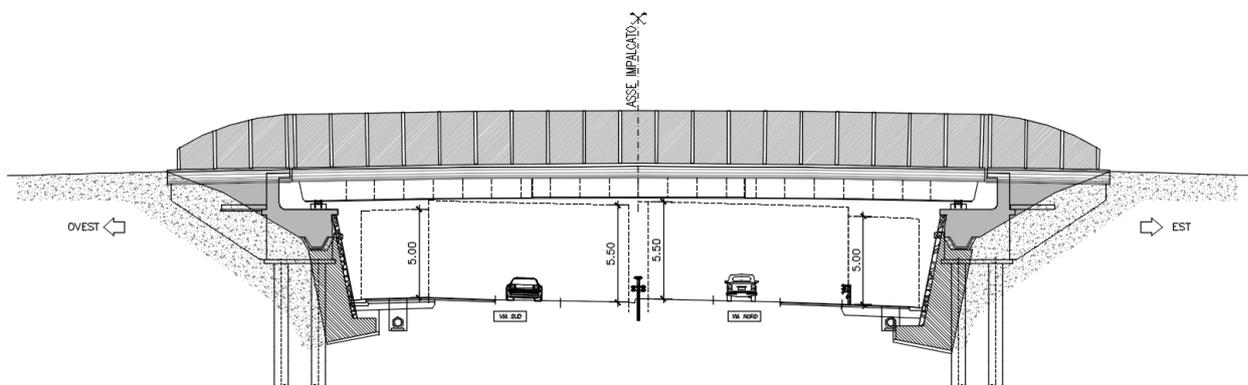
Sezione longitudinale del nuovo sovrappasso n. 69
